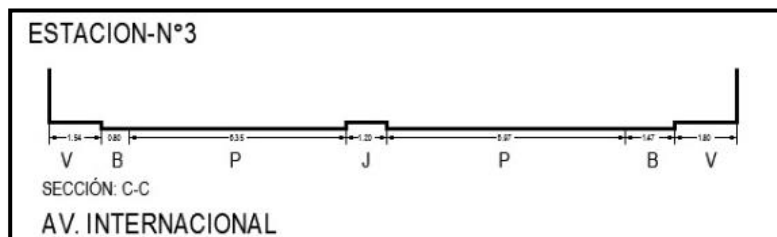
Corte C-C Sección Vial de la Av. Internacional
